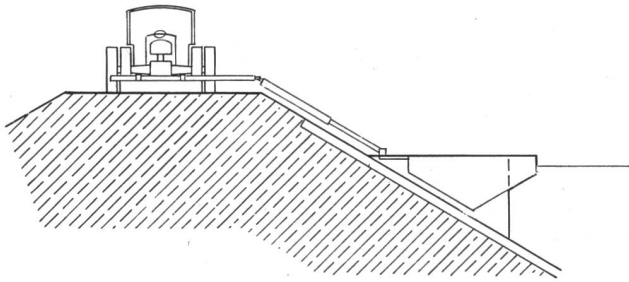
Schnitt durch die Kanalböschung mit dem kleinen Stahlkasten zur Sanierung der Betonplatten. Auf der Dammstrasse steht der Traktor des Arbeitszuges. Gleicher Massstab wie Bild 3.
